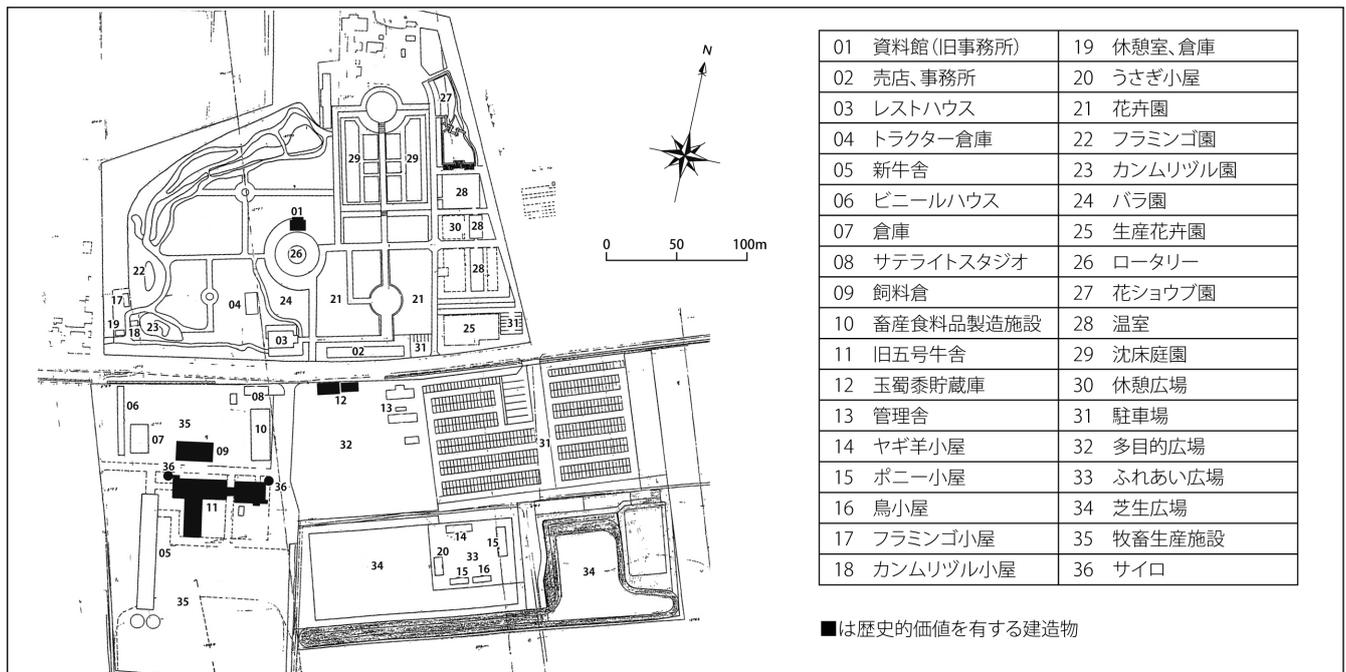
施設配置図 (有限会社イワセファーム所有の施設配置図に筆者が追記)
